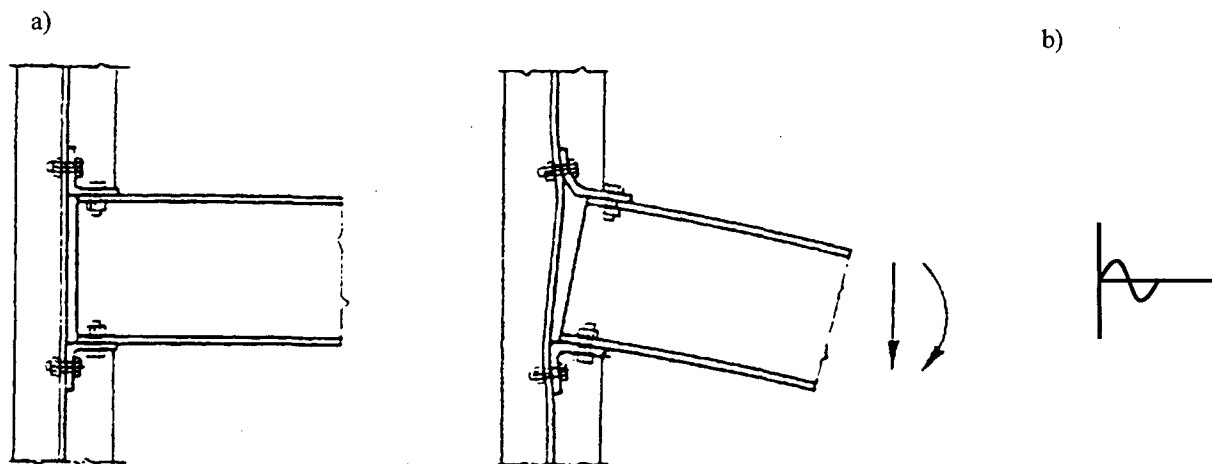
Conexão semi-rígida para viga orientada na alma do pilar, segundo Kirby et al (1996), e seu modelamento.
